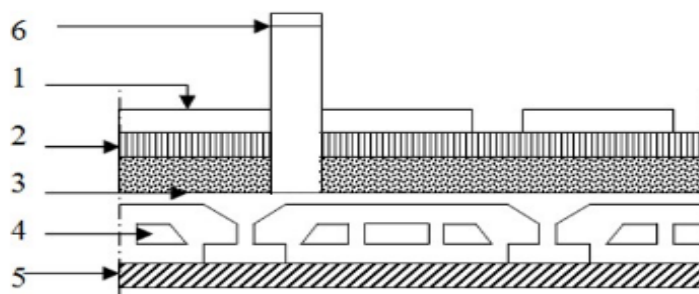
Coupe verticale du plancher étage courant.
